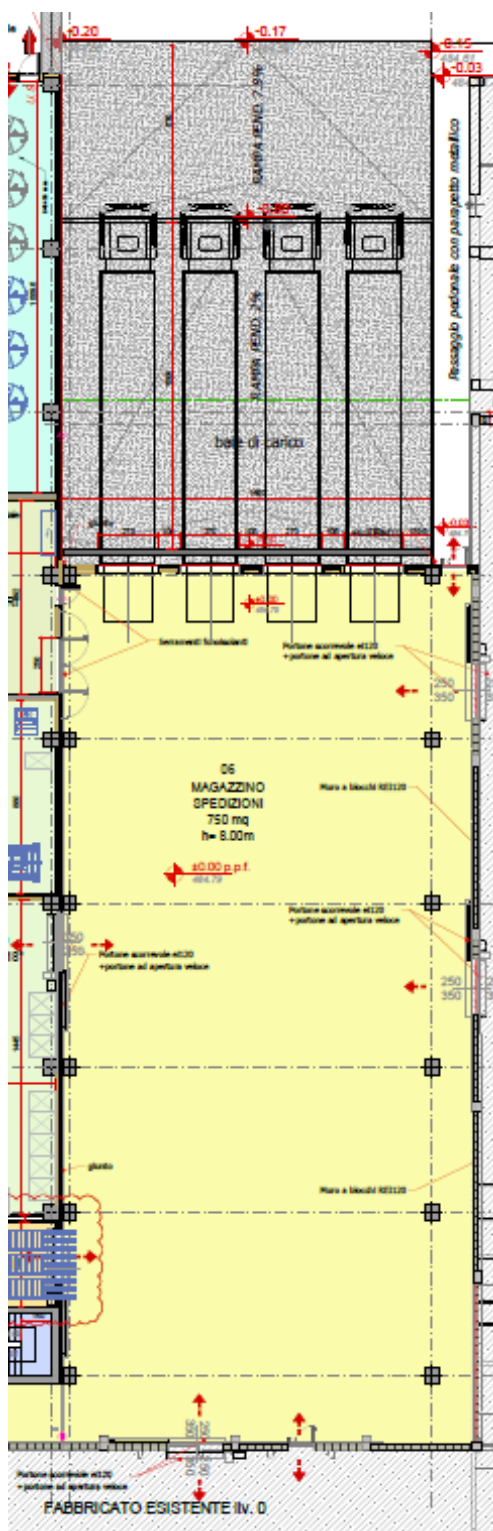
Planimetria architettonica piano P0 - Nuovo magazzino spedizioni
